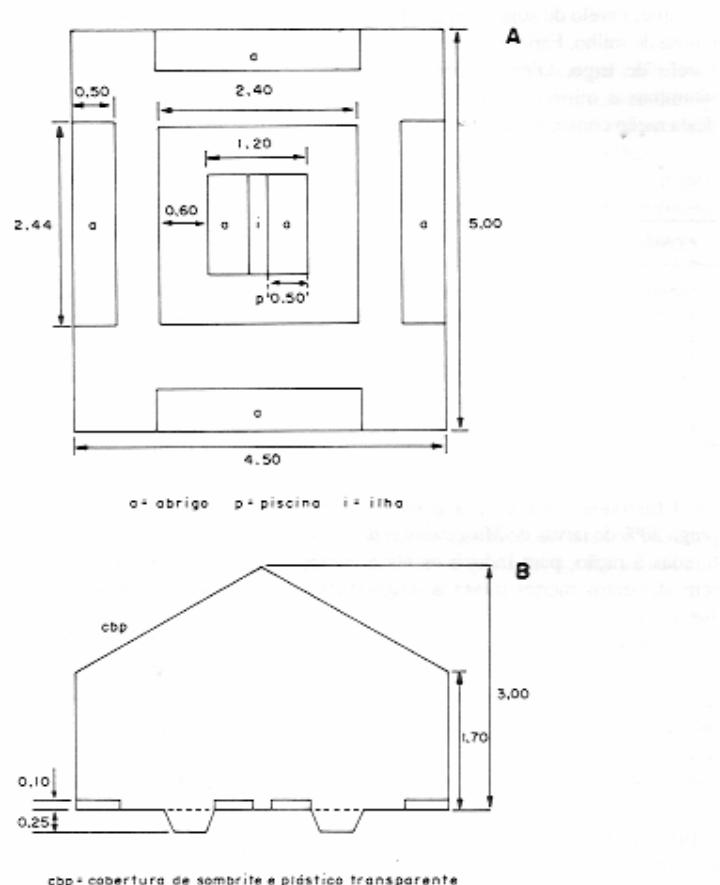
Sistema Tanque-Ilha: Planta baixa (A) e corte transversal do Tanque-Ilha (B) (medidas em metro)
